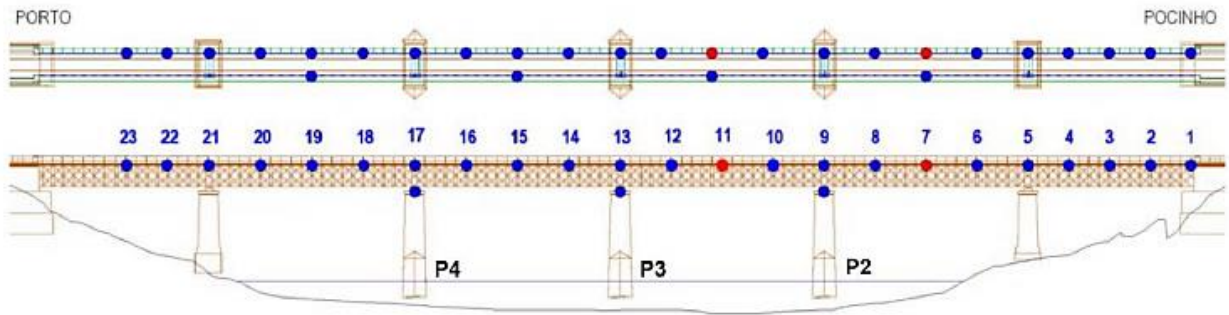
Planta e alçado com a numeração dos pontos instrumentados no ensaio (adaptado de Magalhães e Cunha, 2011).
